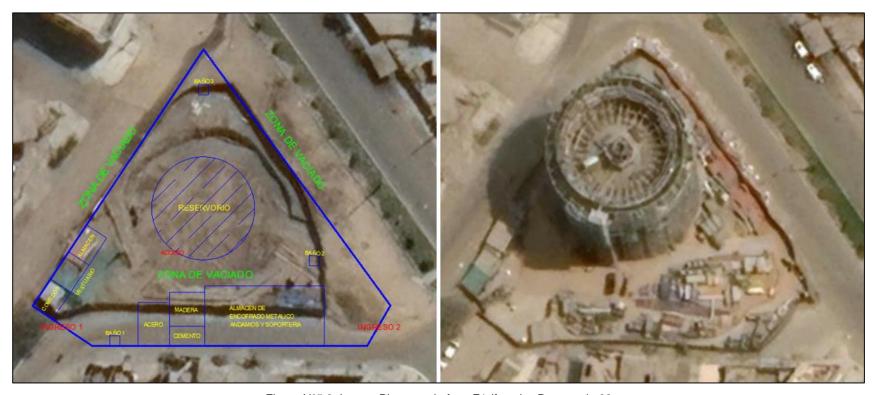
Layout Plan para la fase F1 (fuste) – Reservorio 03.
